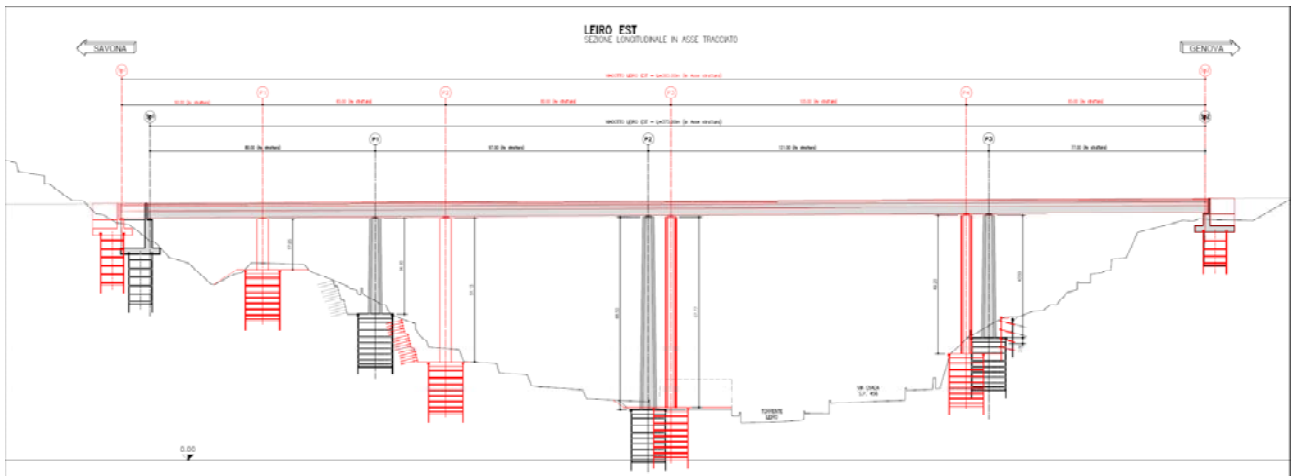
Variante progettuale: profilo longitudinale (in rosso l'ubicazione delle pile nella soluzione originale)
